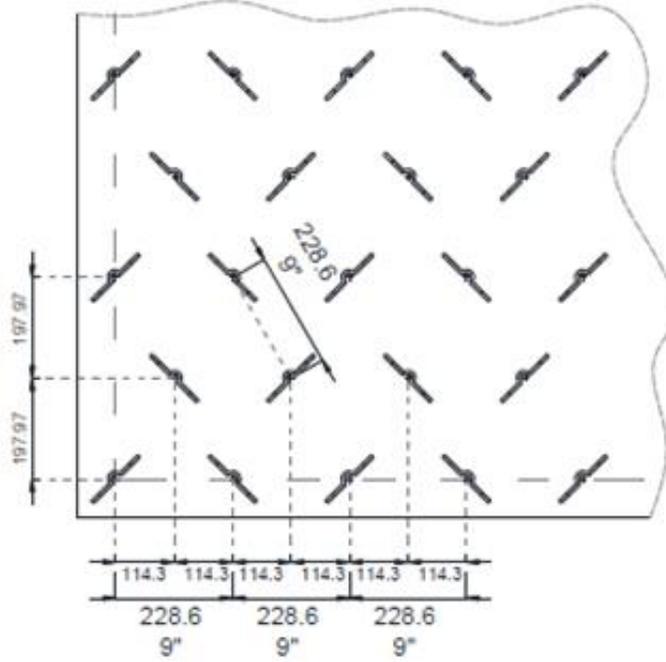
Distribución de anclas en techo. Fuente: Planos del proyecto
